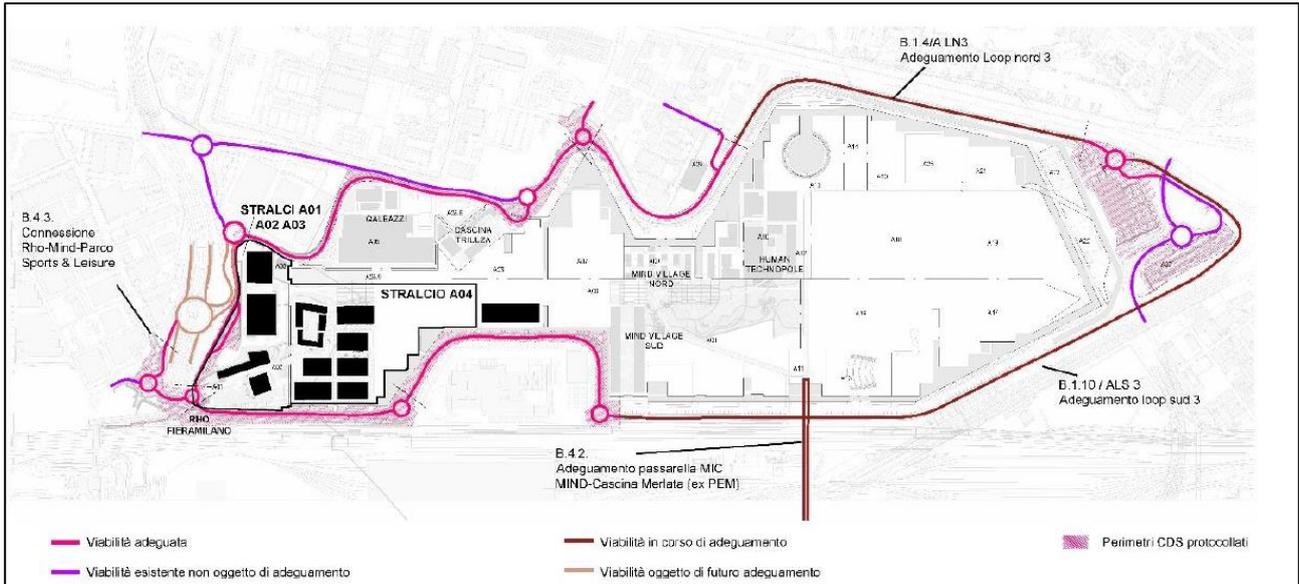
Planimetria di MIND all'orizzonte T4 (fonte STUDIO MIND)
